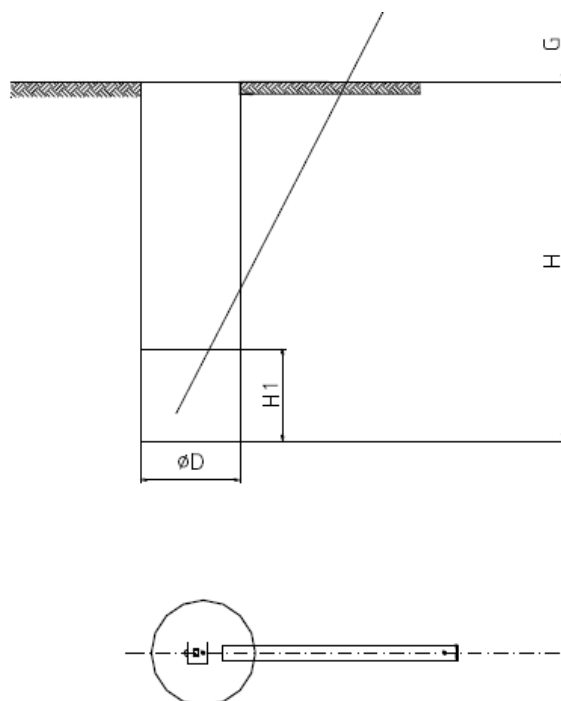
Sapatas típicas para estrutura autoportante (Fonte: ATE XVII, 2013).
